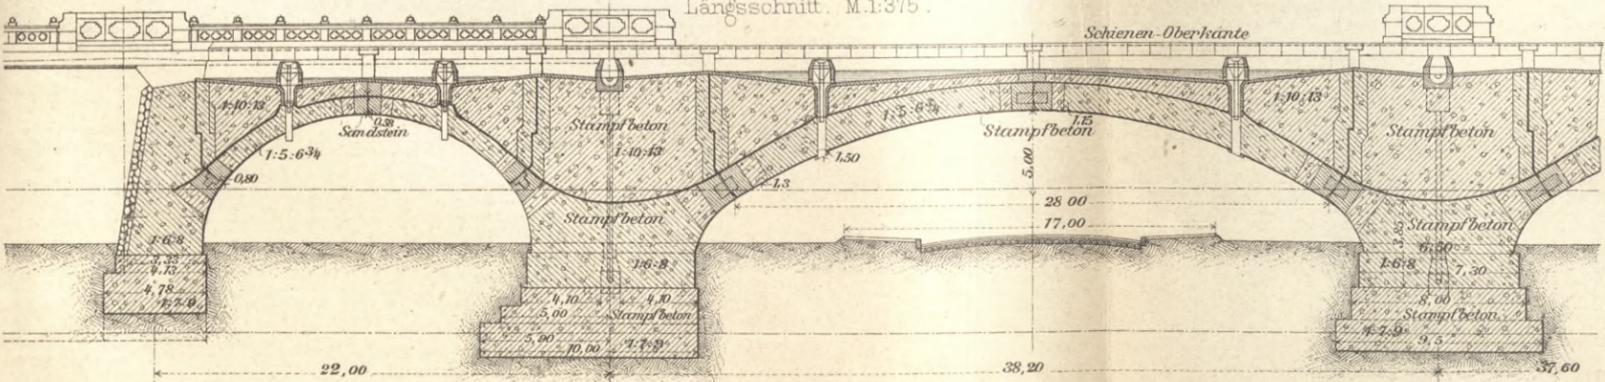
Muldebrücke bei Niederschlema (Sachsen).
